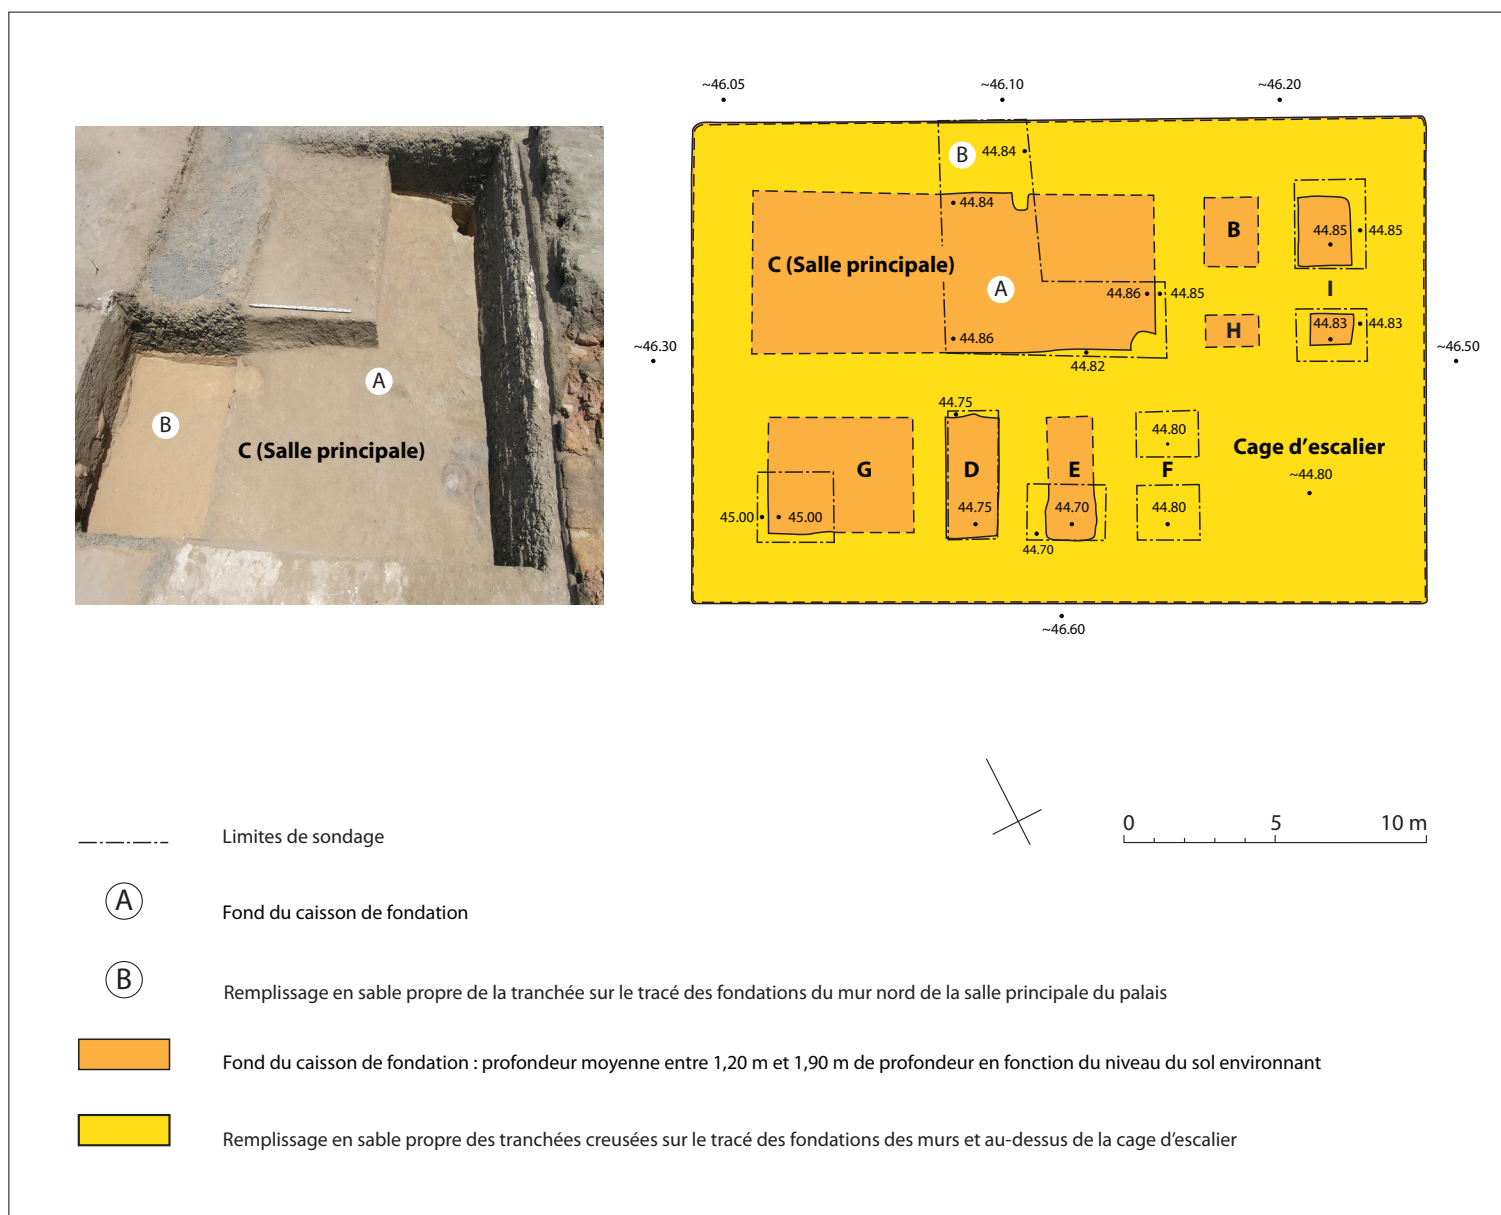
Fondations du palais : remplissage en sable des tranchées sur le tracé des fondations des murs
